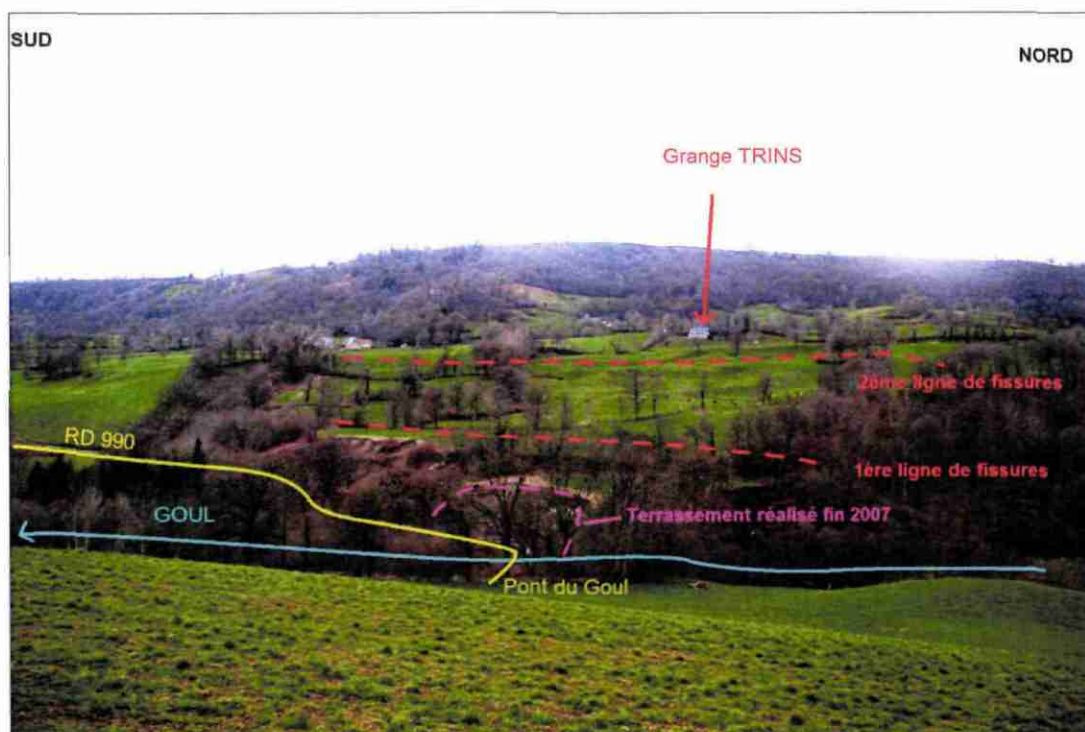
Situation générale du glissement du Pont du Goul en avril 2008 (photo BRGM)
